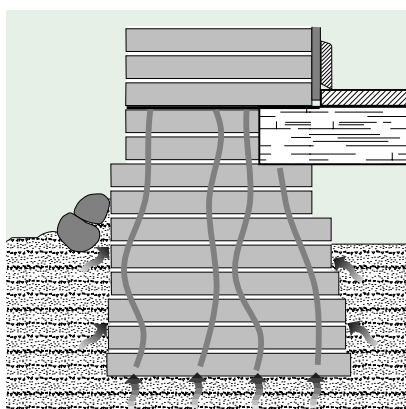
Muret fundament med mekanisk grundfugtspærre.
